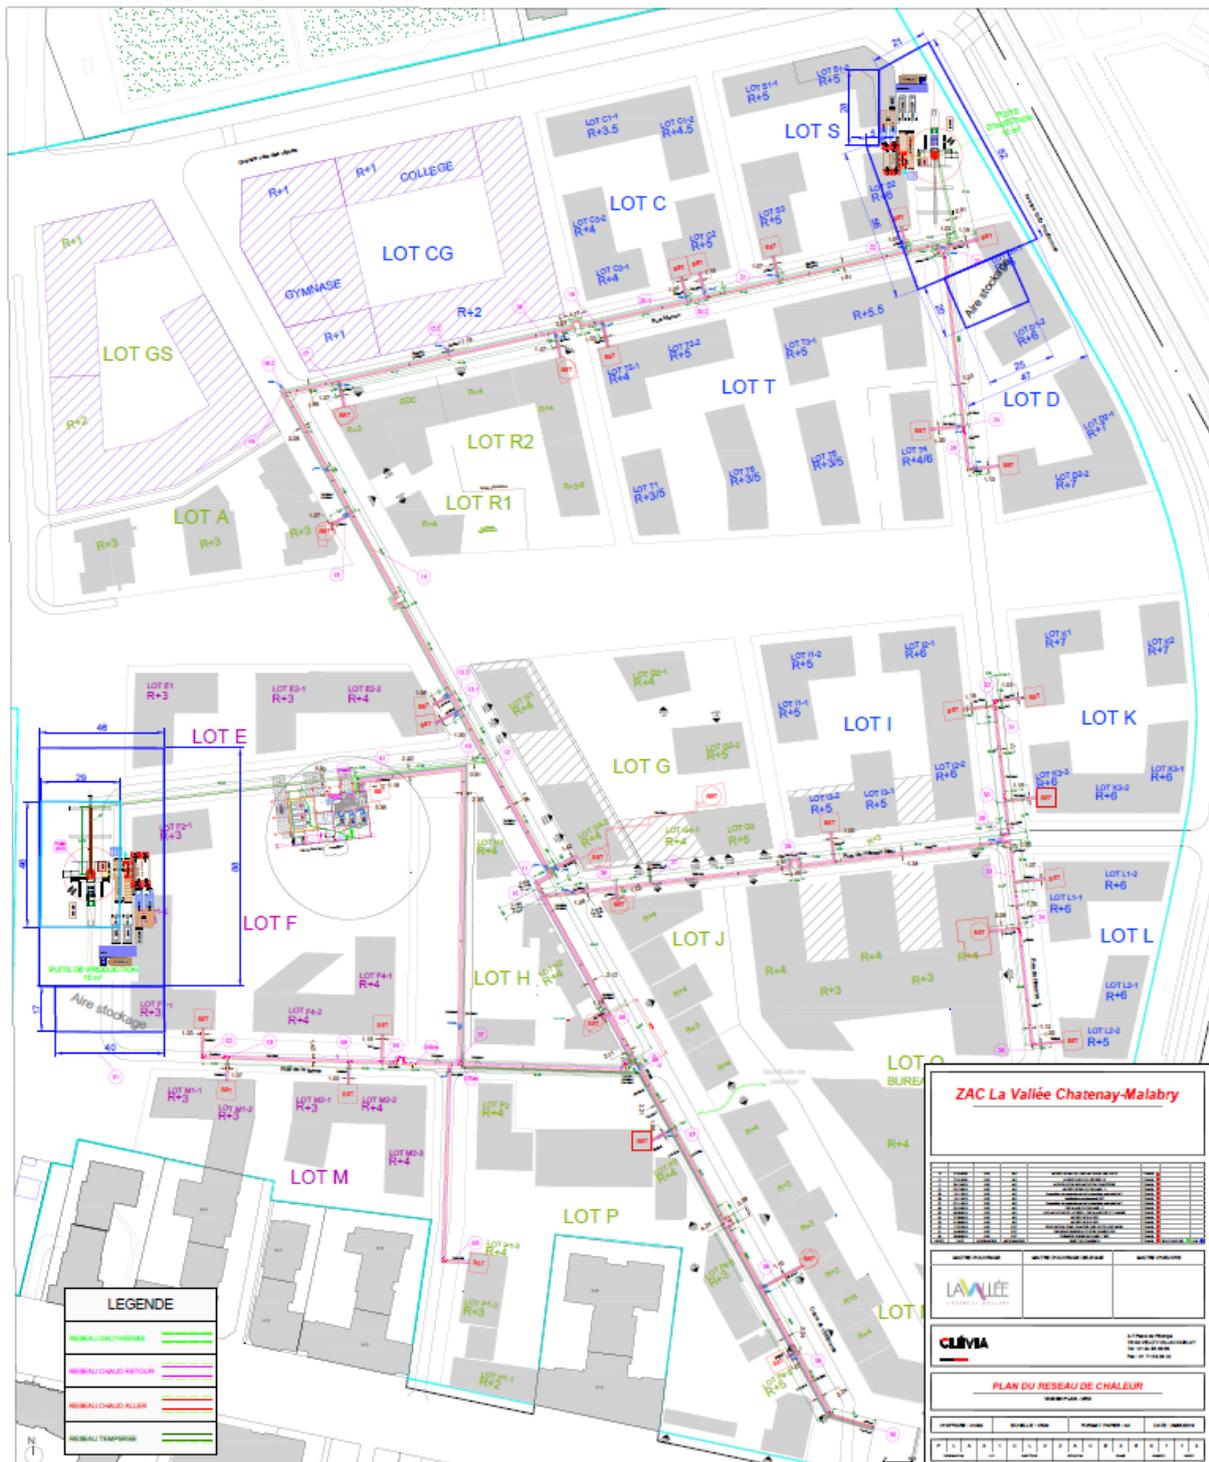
Plan du réseau de chaleur projeté sur la ZAC
